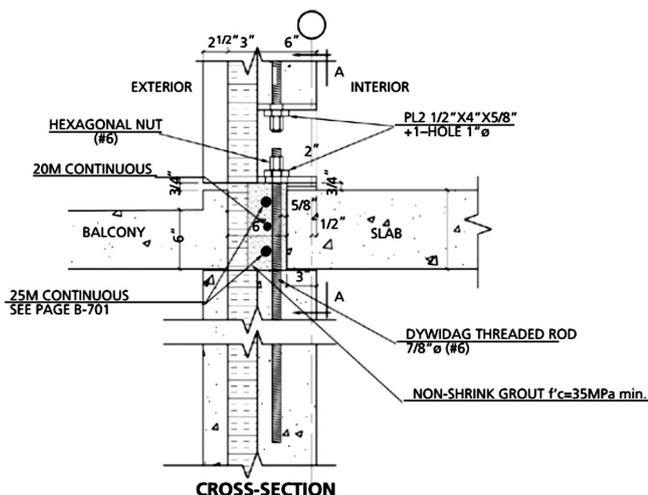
LIGAÇÕES SOLDADAS ENTRE LAJES
